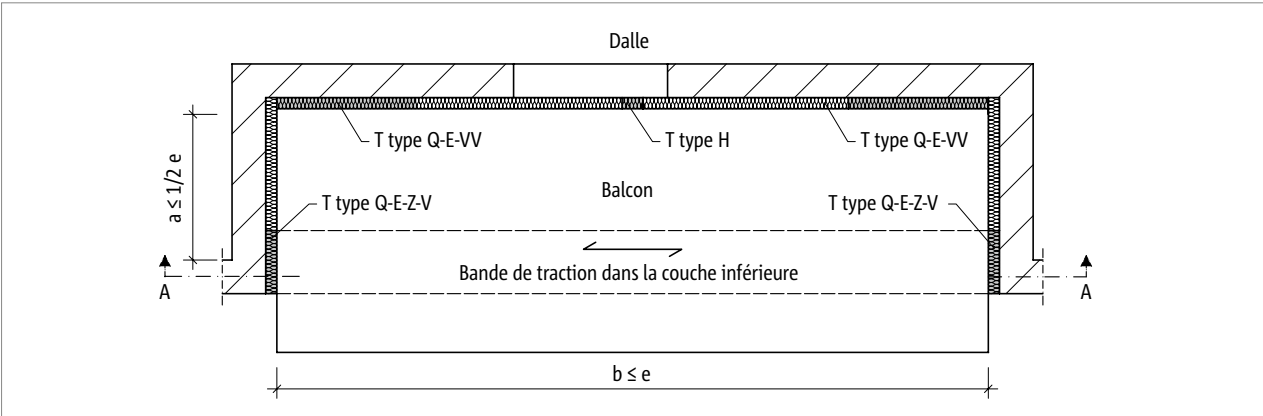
Schöck Isokorb® T Type Q-E-Z-V : Plan de base loggia - symétrique
